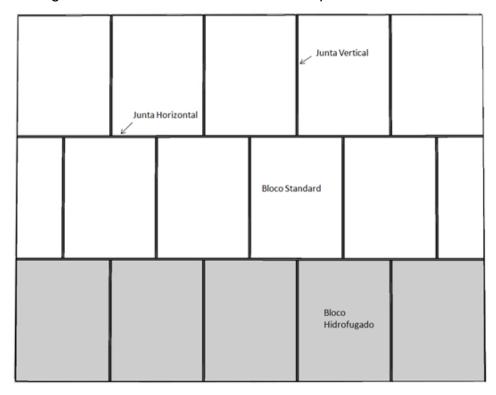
Ligações entre os blocos de gesso – amarração entre fiadas
